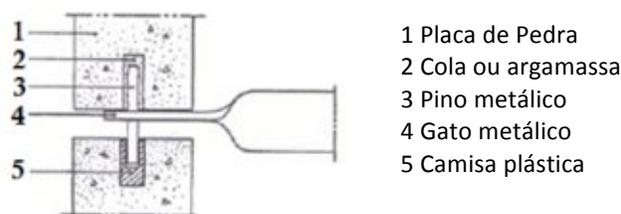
Esquema em corte da aplicação de um gato metálico para suporte de placas de pedra [16]
